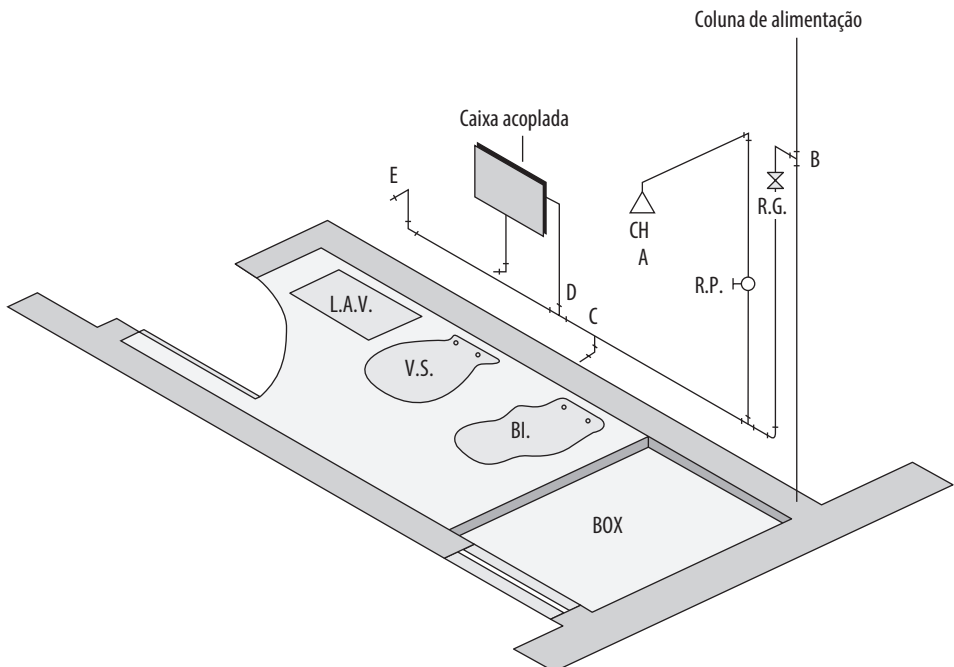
Planta de sanitário com isométrico aplicado.
